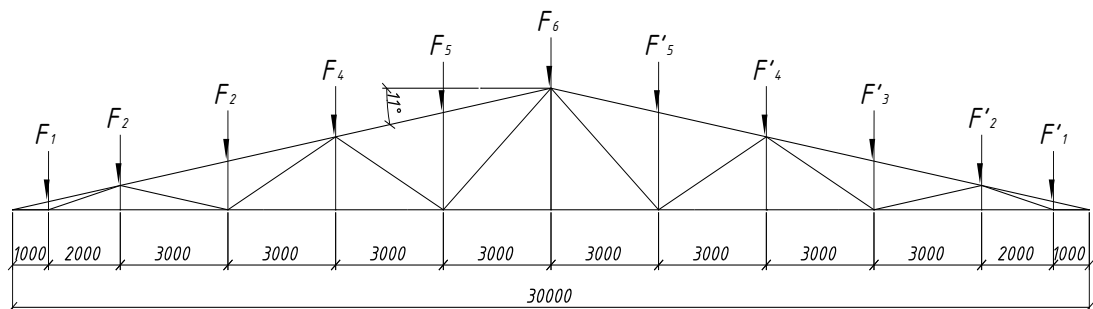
Нагрузка, проходящая на каждый узел фермы
